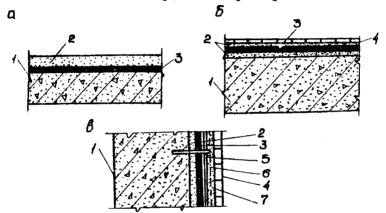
Устройство гидроизоляции конструктивных элементов жилых, общественных и промышленных зданий а-мелезобетонная плита балкона; б-железобетонное перекрутие; в-стена плавательного бассейна І-железобетонное основание; 2-выравнивающая стяжка или штукатурка; 3-полимербитумная гидроизоляция; 4-керамическая или облицовочная плитка; 5-металлический дюбель; 6-металлическая с ячейками 50х50 мм; 7-полимерцементный раствор
